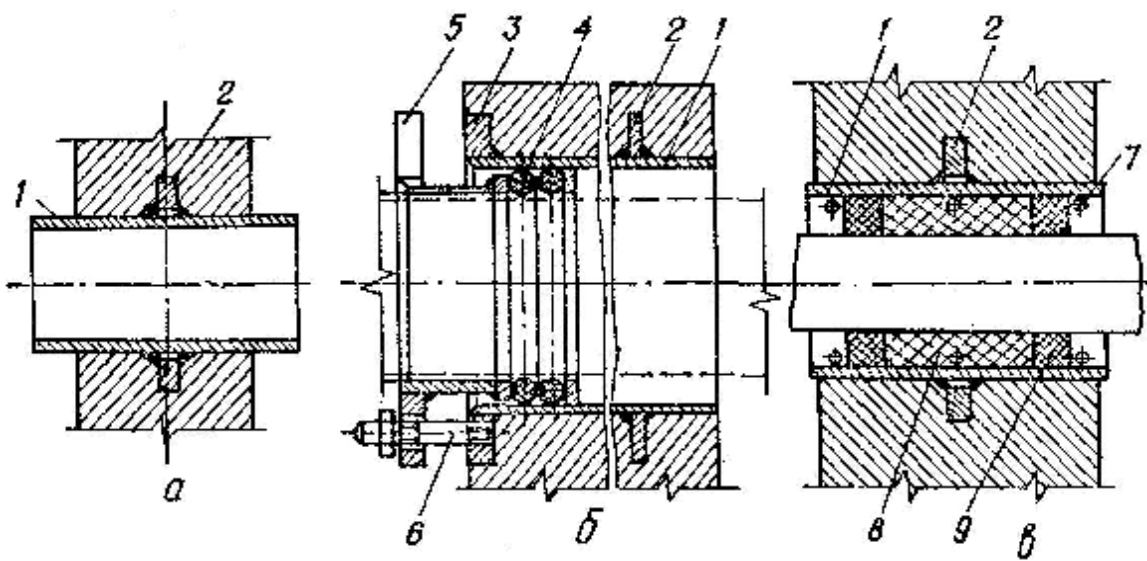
Устройства для прохода трубопроводов через стену: *а* – ребристый патрубок; *б* – сальник с нажимным устройством; *в* – набивной сальник; 1 – корпус; 2 – кольцевое ребро; 3 – фланец; 4 – уплотнитель; 5 – фланцевый нажимной патрубок; 6 – шпилька; 7 – упорное кольцо; 8 – сальниковая набивка; 9 – зачеканка
